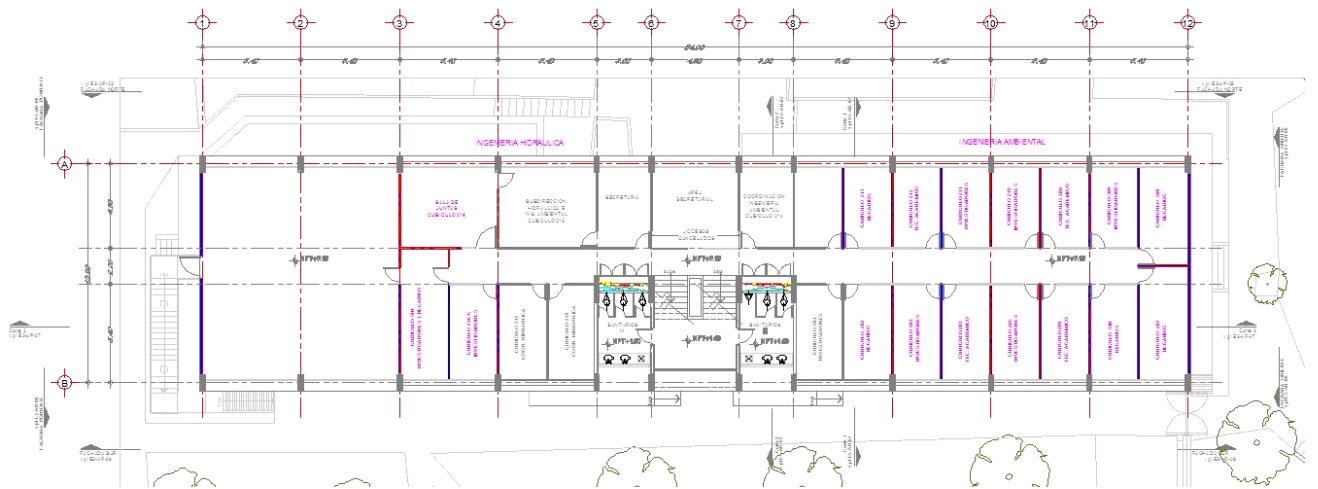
Plano en planta del edificio 5. En él se incluyen los puntos de consumo de agua.
